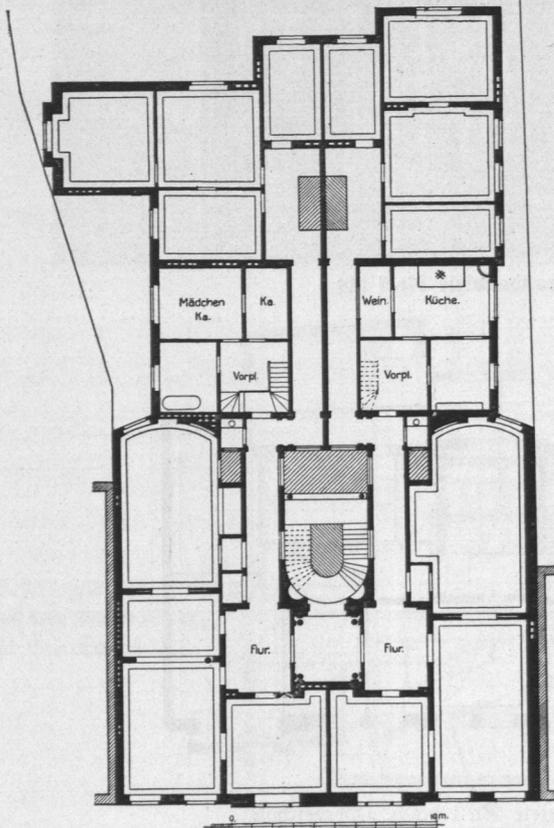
und 962. Haus An der Alster Nr. 21, Ansicht und Grundriß.
